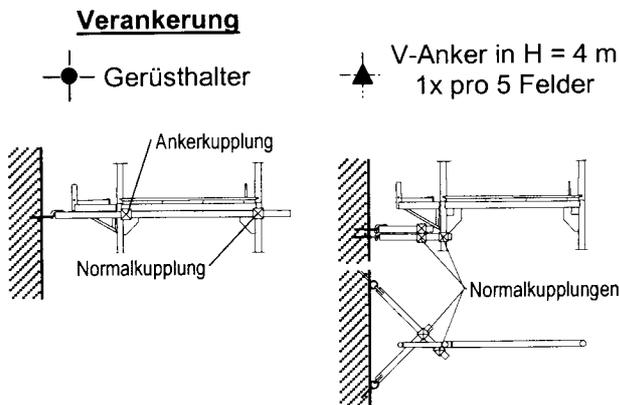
Unbekleidetes Gerüst, Konsolvariante 1, $L \leq 2.57$ m
